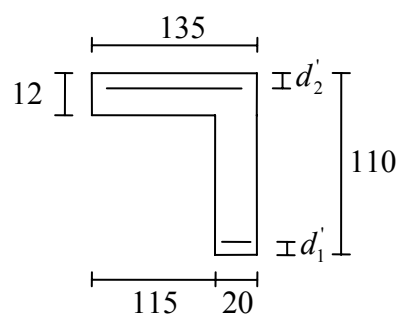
Seção transversal da viga V_1 do Exemplo 1 (em cm).
